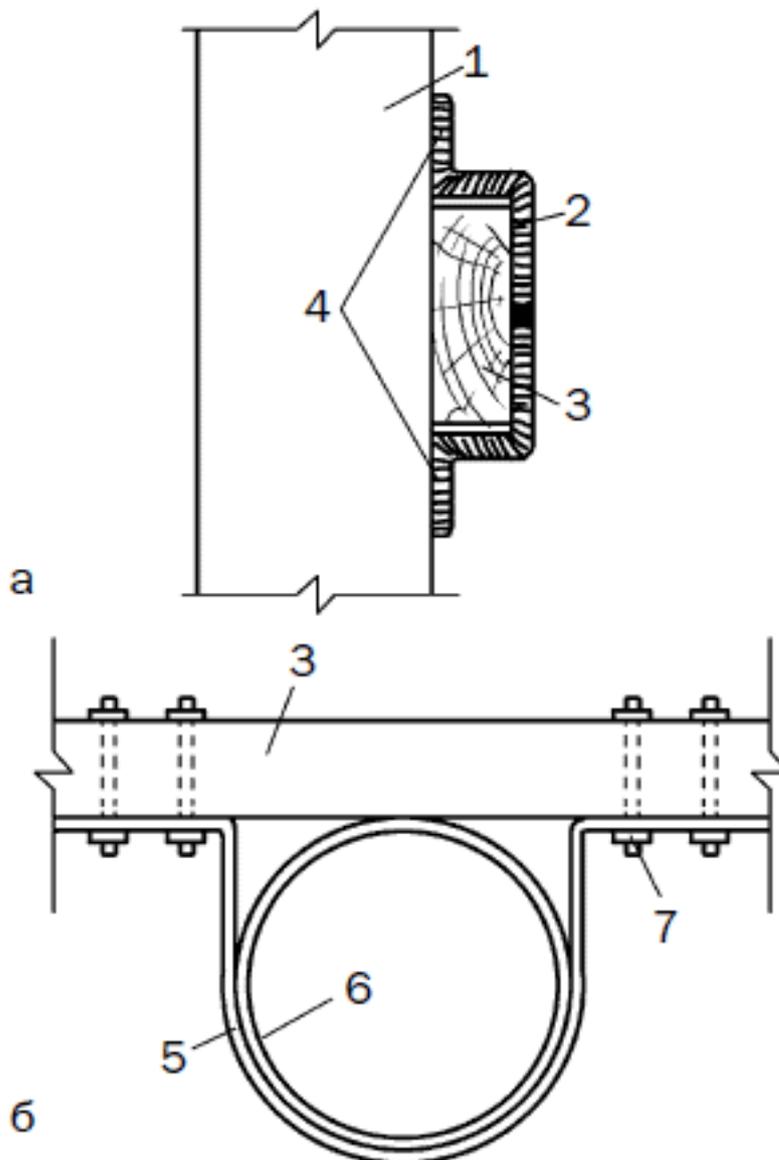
Выполнение крепления поперечин к столбам: а – к металлическому столбу; б – к асбестоцементному столбу; 1 – металлическая труба; 2 – скоба; 3 – поперечина; 4 – места сварки; 5 – хомут; 6 – асбестоцементная труба; 7 – болт
